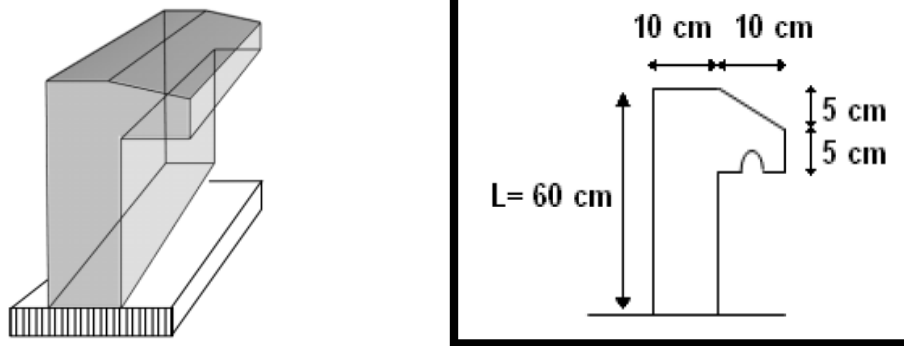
Dimensions d'acrotère Pour terrasse inaccessible
